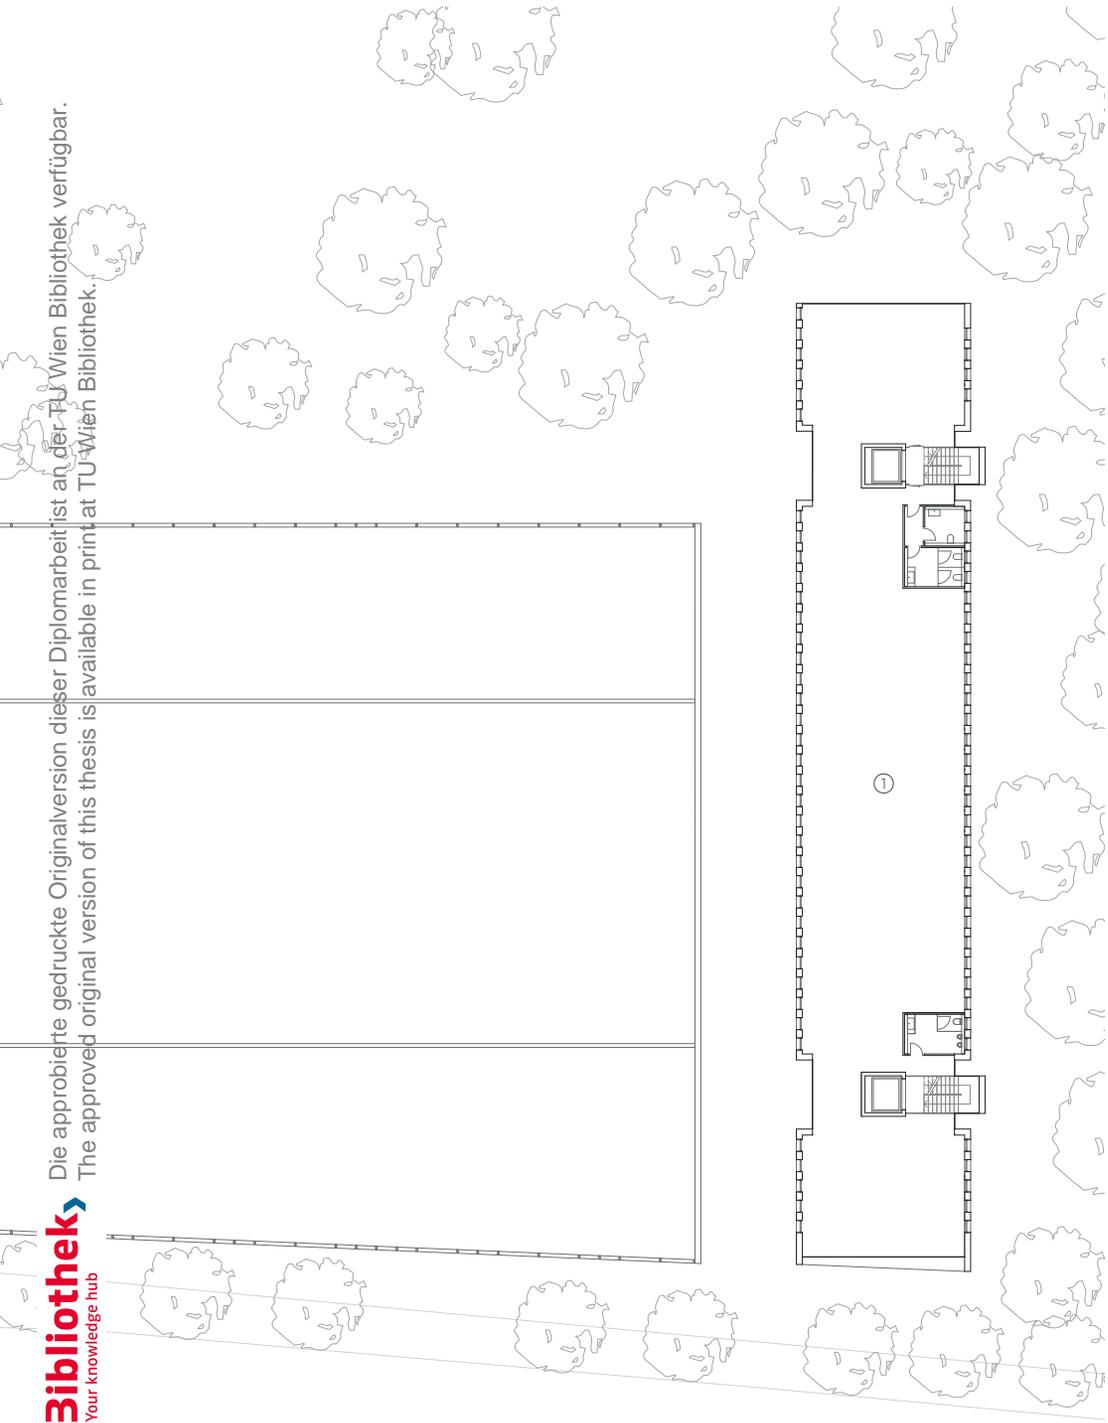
Grundriss 1. Obergeschoss 1:500
